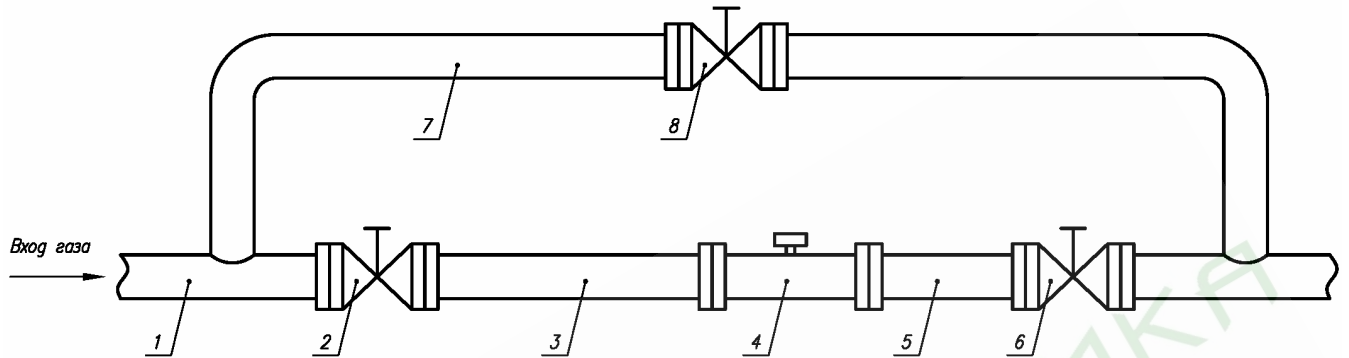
Монтаж счетчика без перепускного клапана
